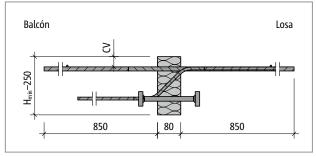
Schöck Isokorb® T tipo K-M7 hasta M11 en R0: Sección del producto
